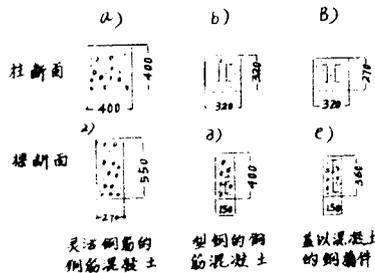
堅固性一樣的用靈活鋼筋的鋼筋混凝土断面
